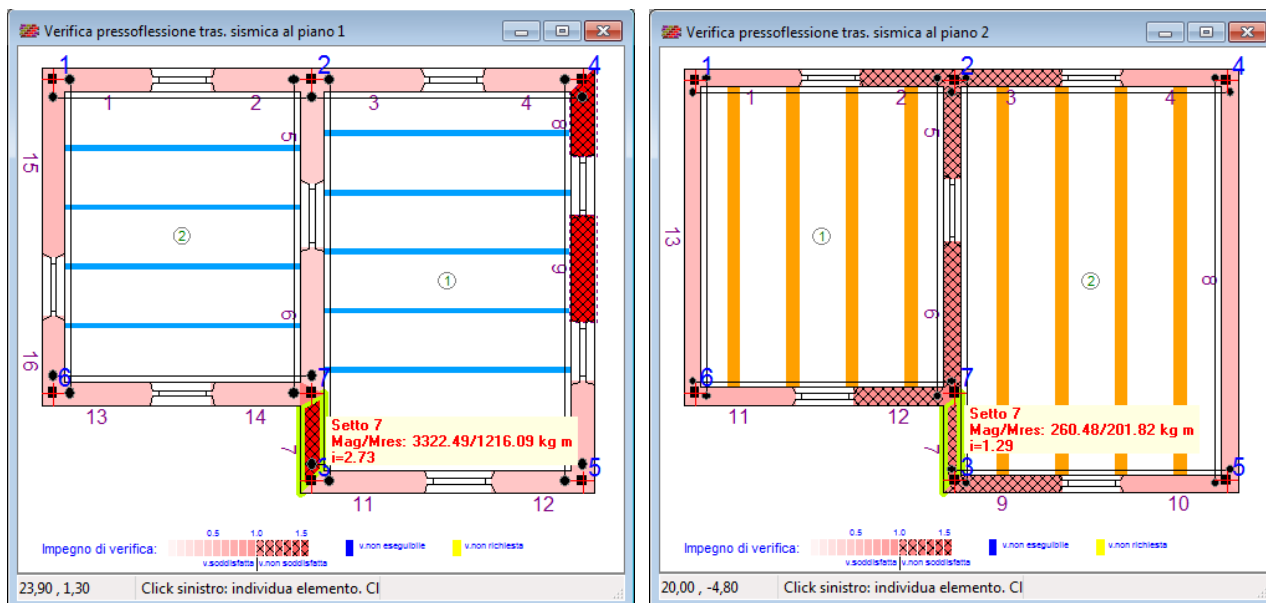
Vista piante con rappresentazione delle zone critiche e del tipo di collasso.
